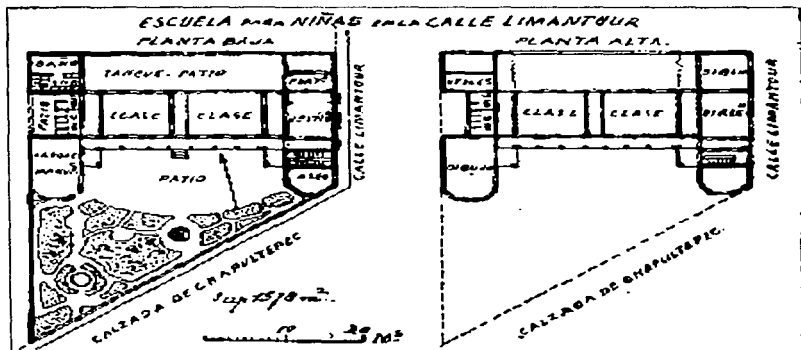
2 1 1 (20) Planta arquitectónica de la escuela Horacio Mann ca. 1909.
